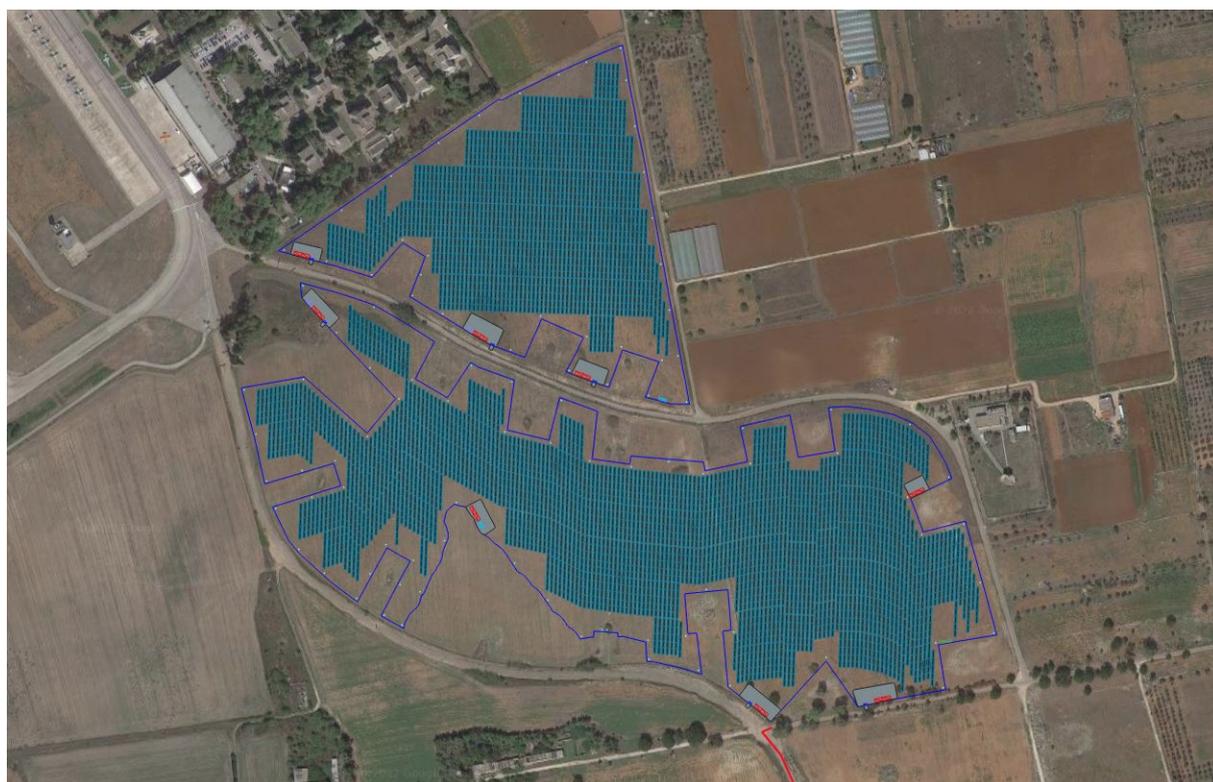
Progetto Pinta su ortofoto (layout Fotovoltaico)
